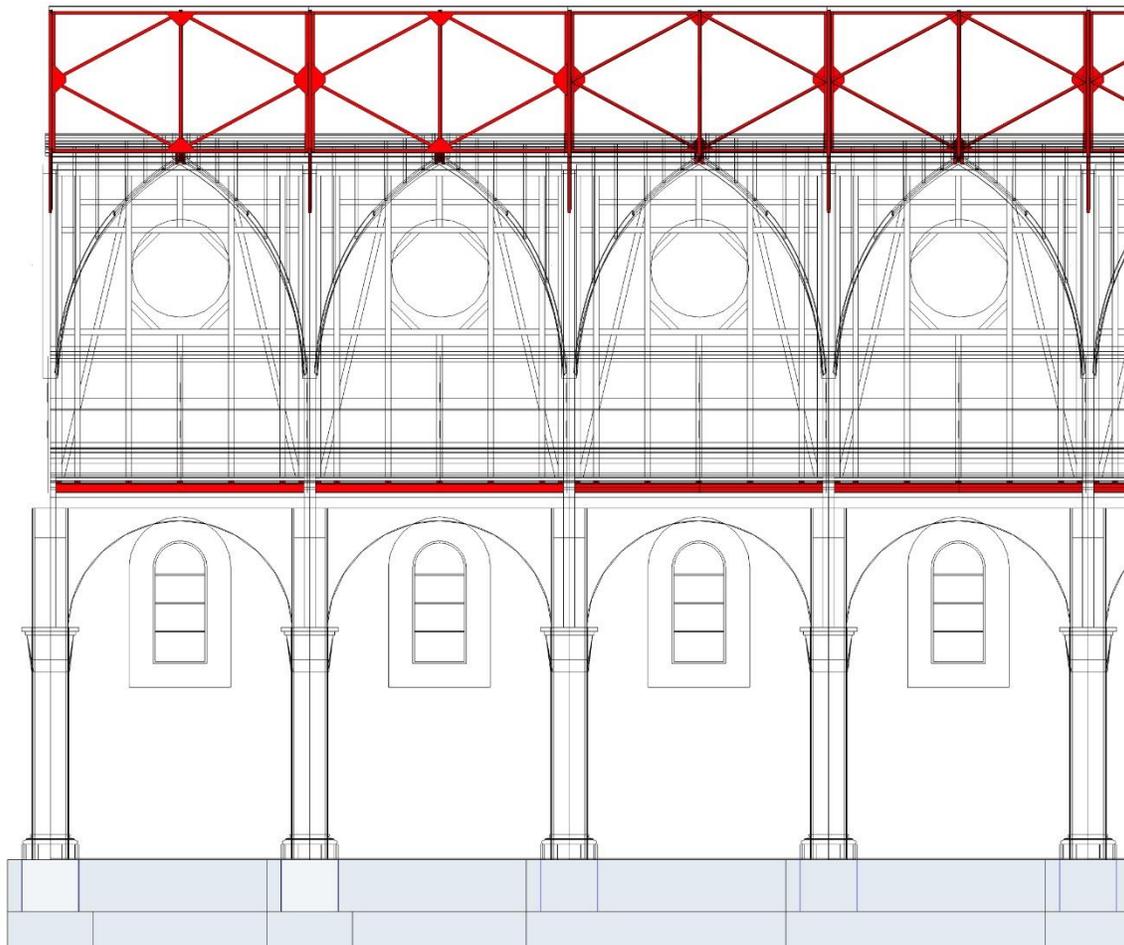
Elevación esquemática de nave y en rojo estructuras metálicas, se observan cruces de san Andrés y viga solera de estructura metálica. Elab. Propia.
